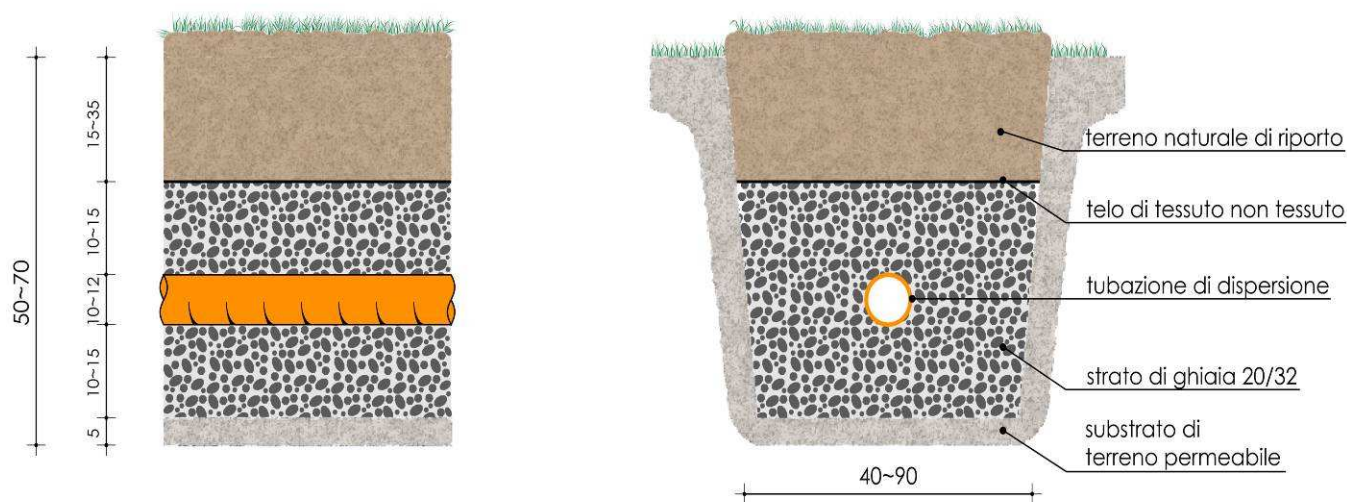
Sezione verticale trasversale di una trincea di un sistema di subdispersione senza drenaggio.
